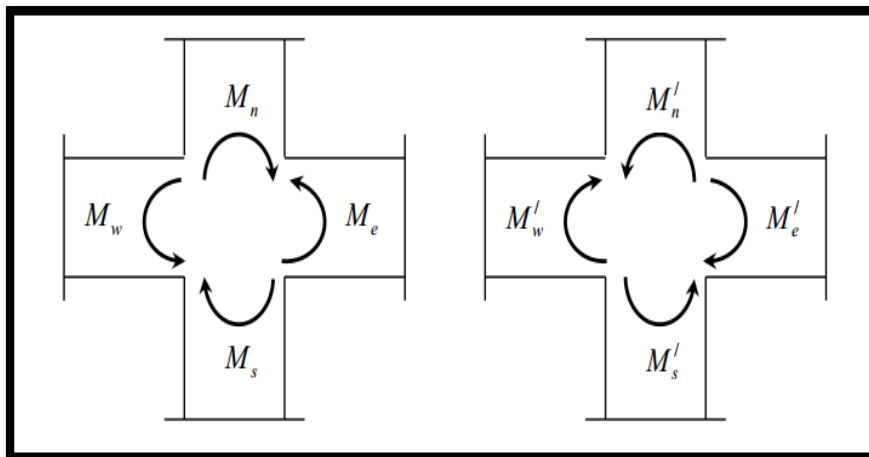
Illustration du dimensionnement d'un nœud poteau-poutre [R5].
